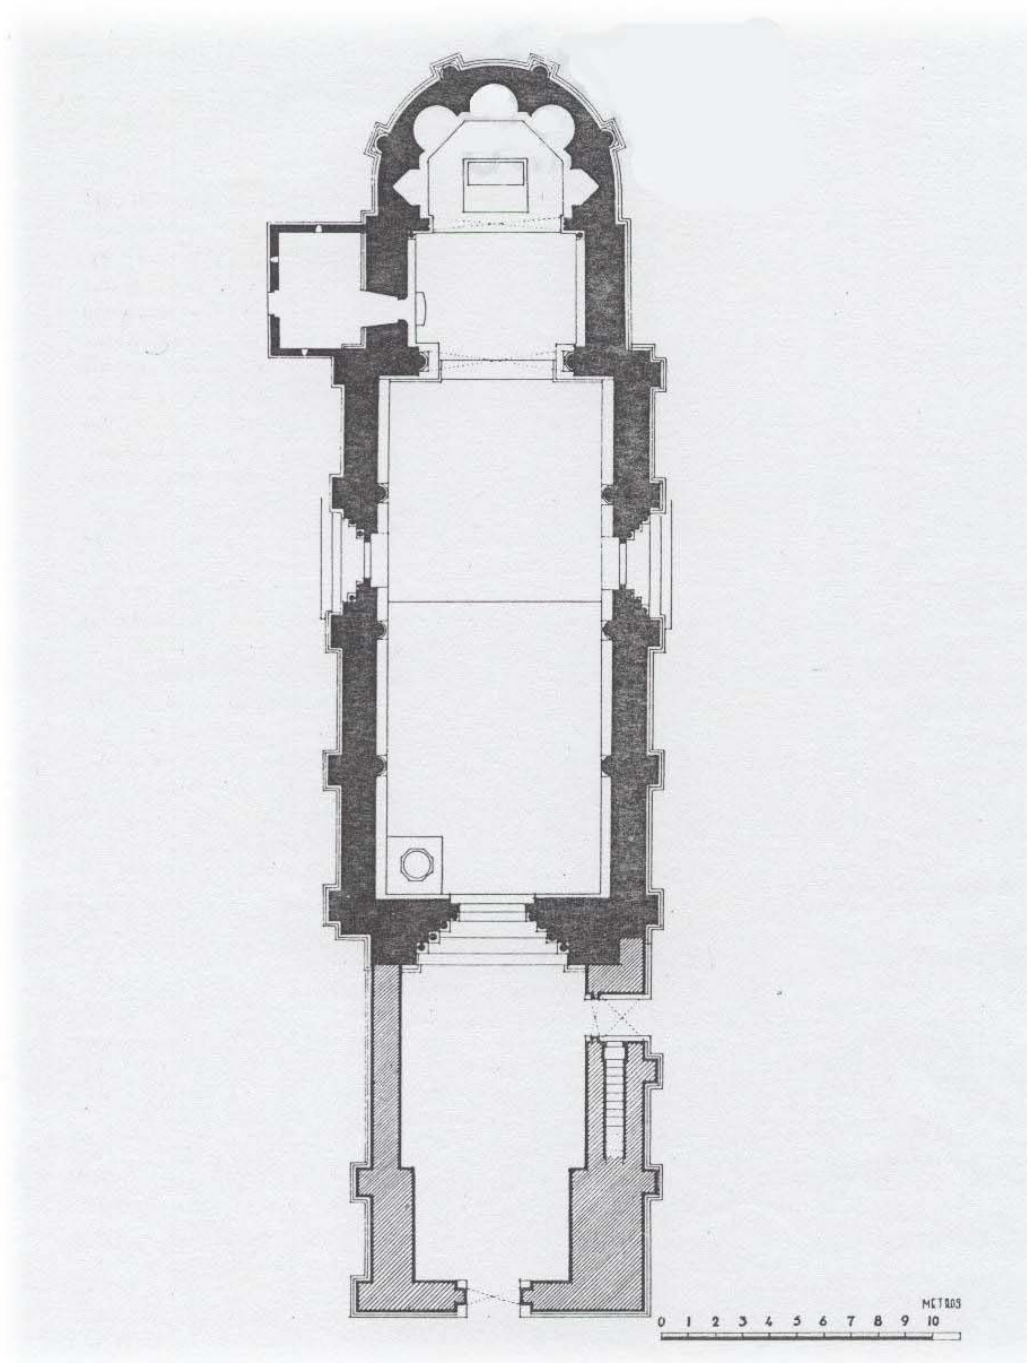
Planta da Igreja de S. Pedro de Ferreira
